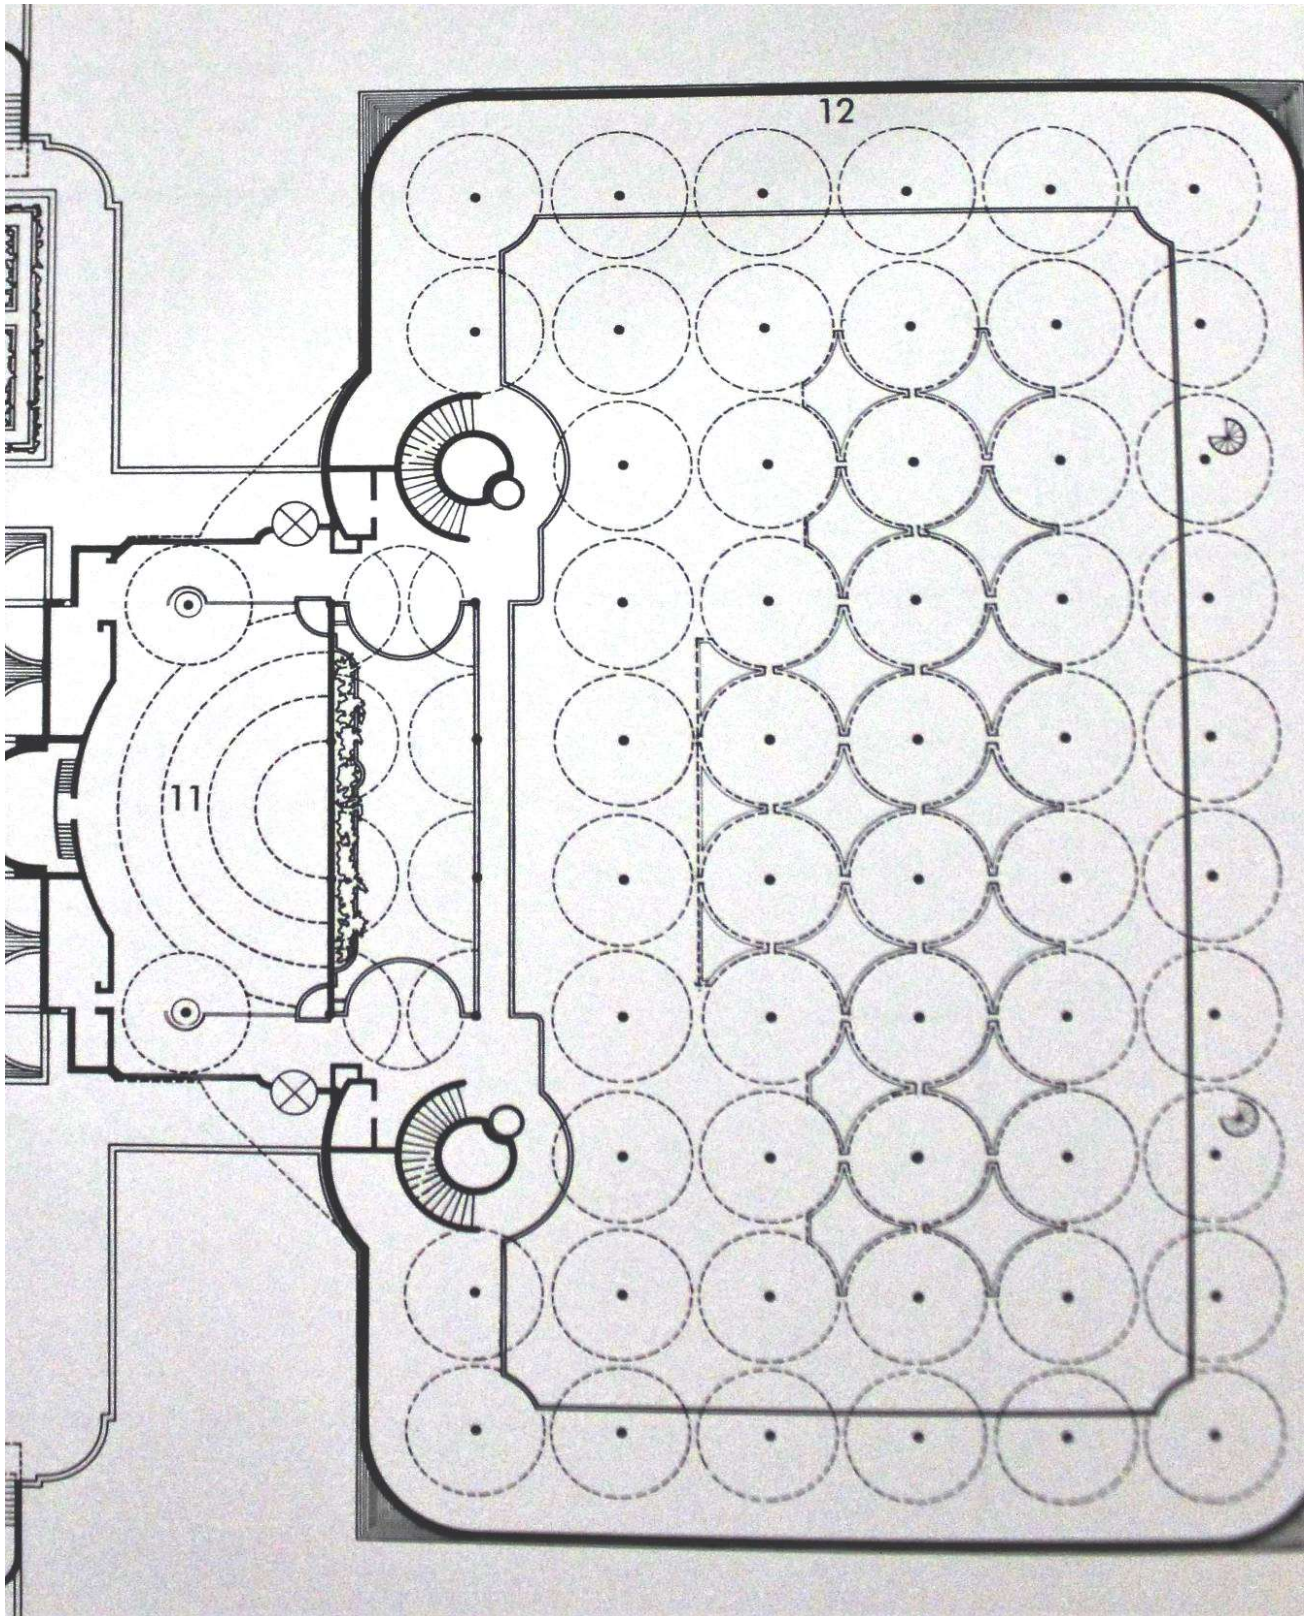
Planta de planta intermedia sobre sala de trabajo.
